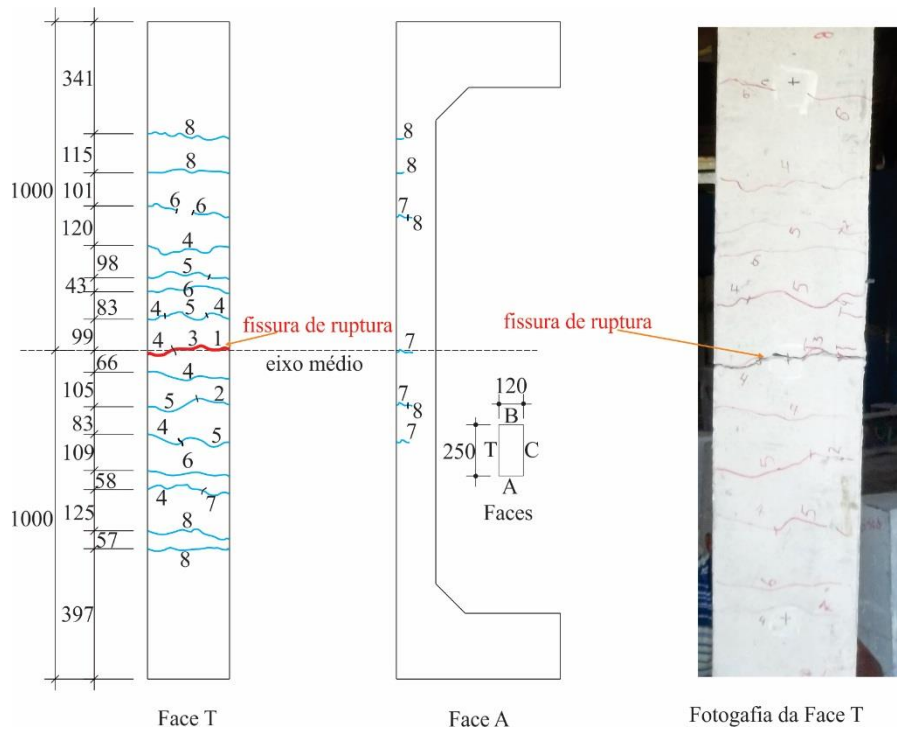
49 - Fissuras nas Faces T e A; Fotografia da face T - pilar original (P_o)
